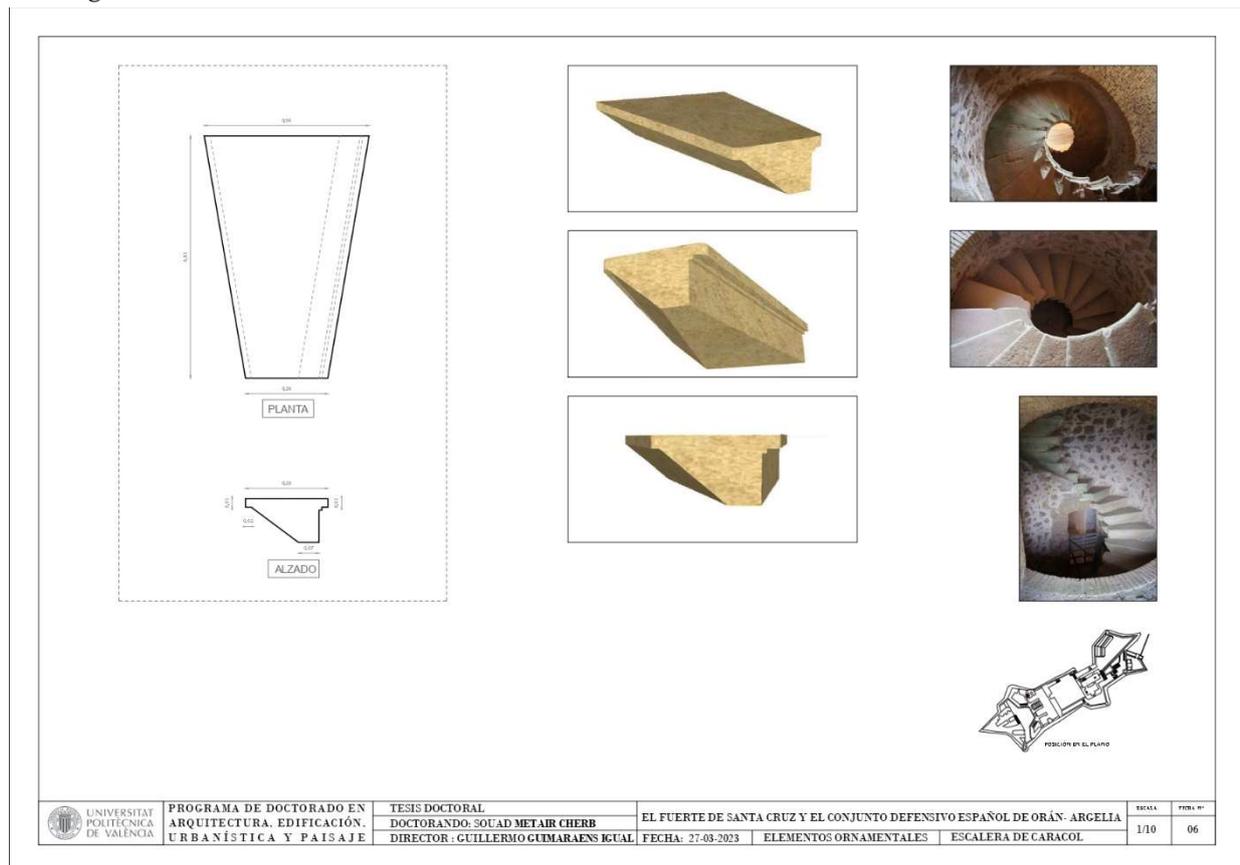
Ficha técnica de la escalera de caracol del fuerte de Santa Cruz (S.M).
